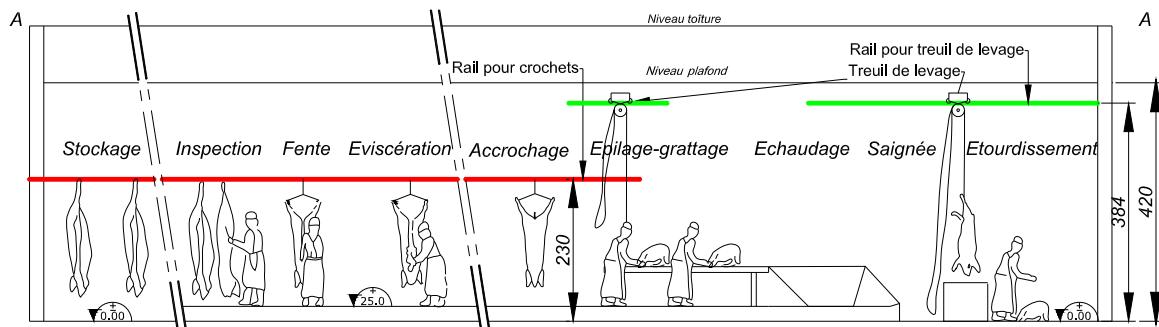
La disposition en hauteur des rails (source : Auteur)
